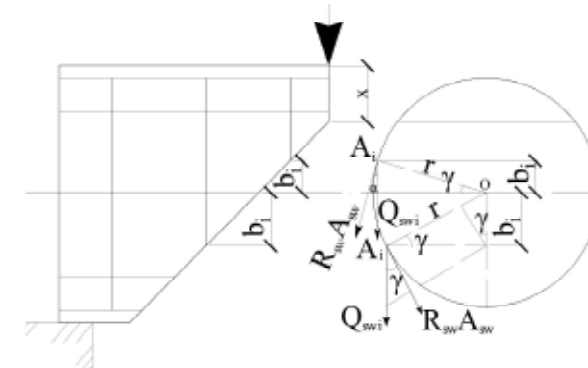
Усилия в поперечной арматуре: A_i – точки пересечения наклонной трещины поперечных хомутов; γ – угол между касательным направлением напряжений и вертикалью; b_i – расстояние от центра до точки пересечения трещины; r – радиус кольцевой арматуры
